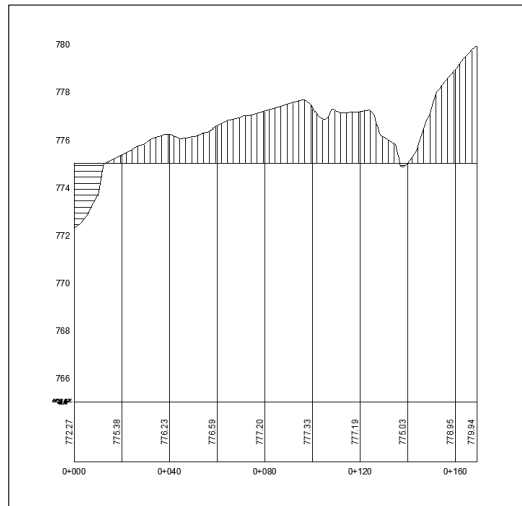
Rencana Elevasi Area 1 Potongan Memanjang Total Station
